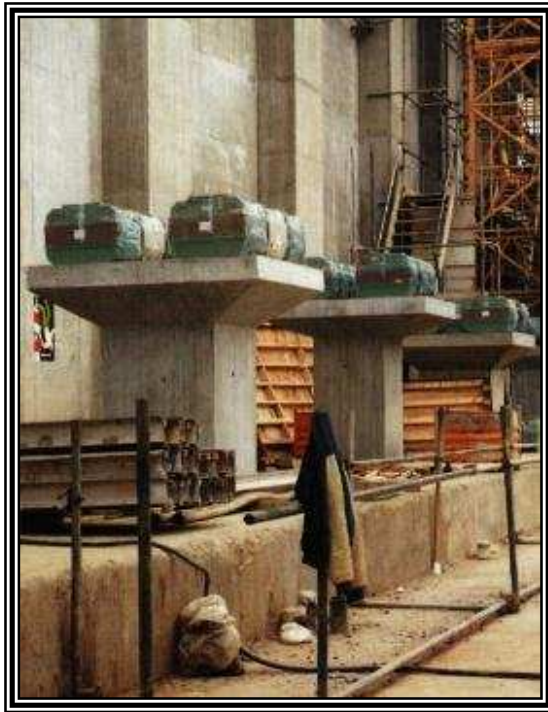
Apoyos de resortes del New Bridge Street Ludgate (bajo construcción).
